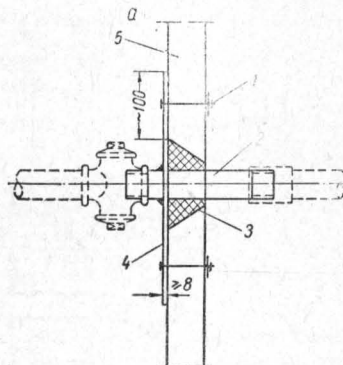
Проход трубопроводов из взрывоопасных помещений одного класса во взрывоопасные помещения другого класса (или другой среды) или в помещения невзрывоопасные или наружу через тонкие бетонные перегородки, подвергающиеся вибрациям и сотрясениям (крепление труб около прохода см. рис. 7, В и расположение приварных патрубков на стальной плите см. рис. 7, А и 7, Б):
